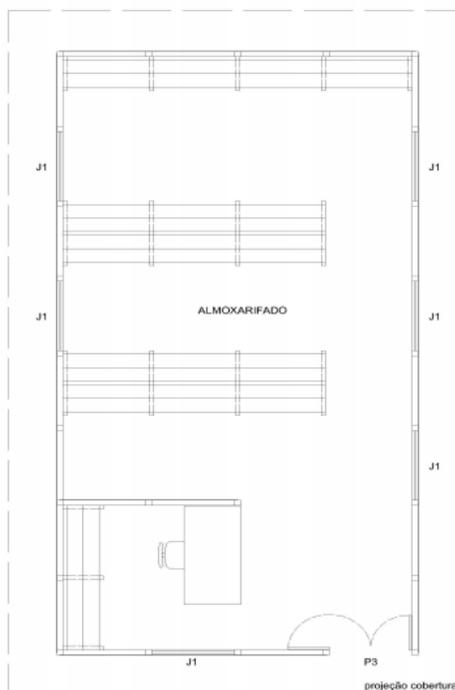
Layout de referência de almoxarifado em canteiro de obra, em chapa de madeira compensada, utilizado para fins de especificação, medindo 10m<sup>2</sup>.
